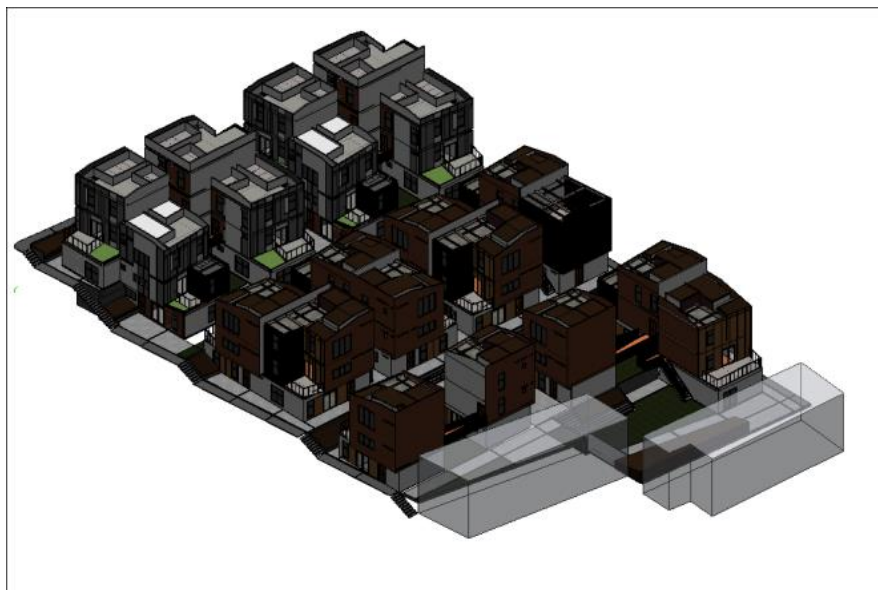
Vista 3d Proyecto Alta Vista. Fuente: Propia
